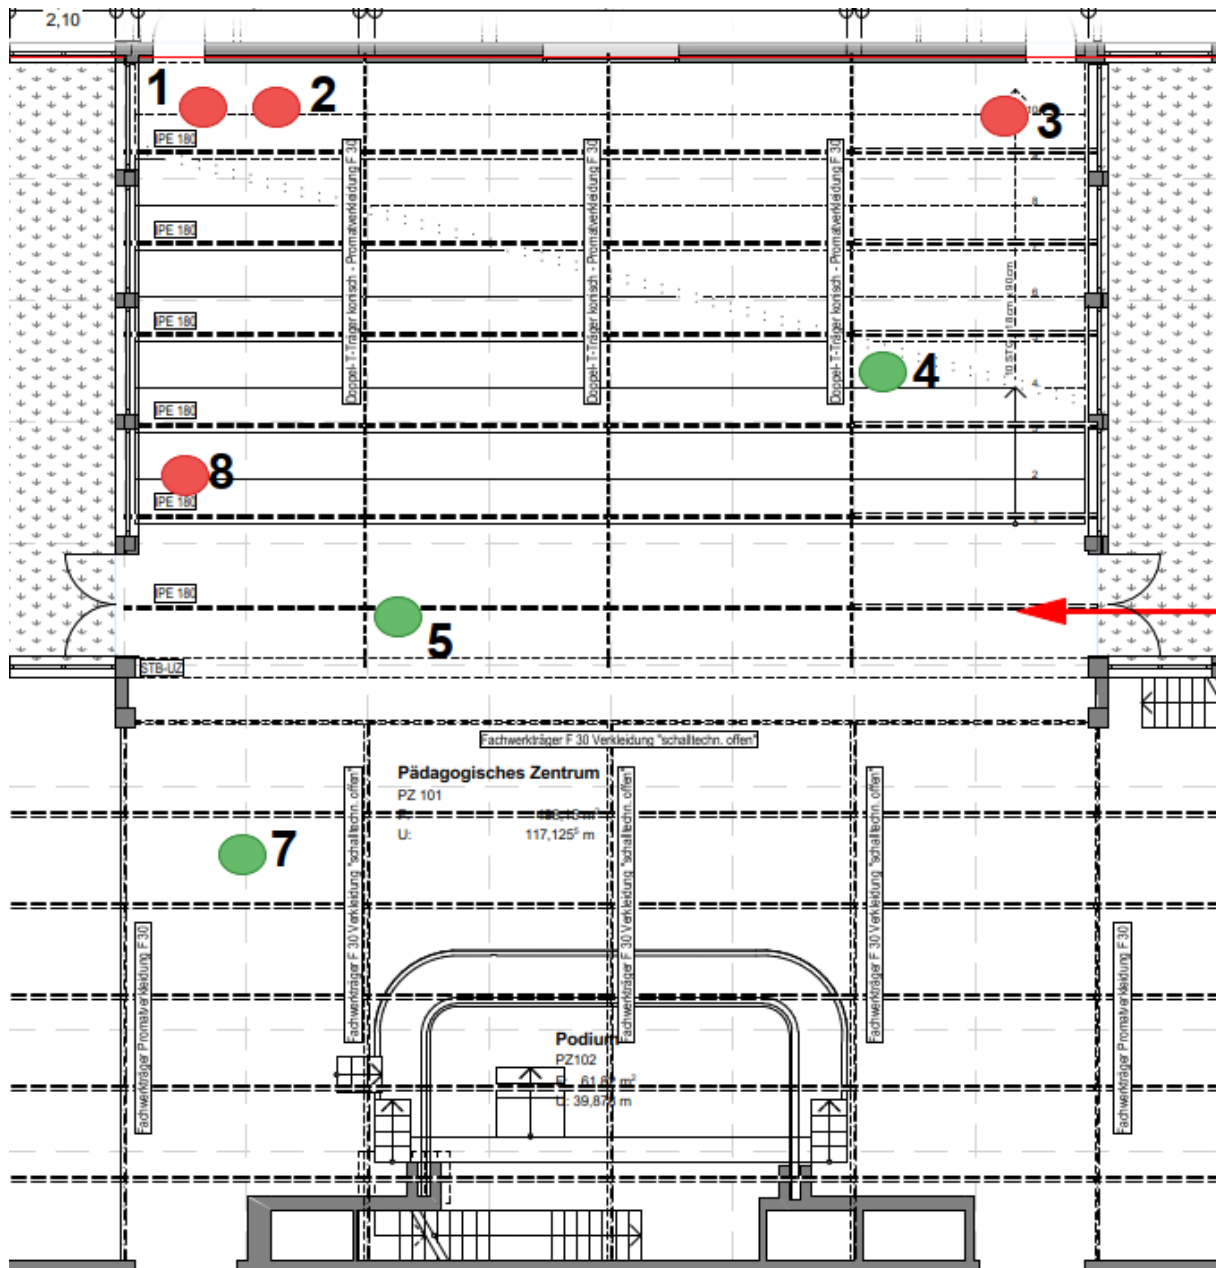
Grundrissausschnitt Ebene 1 (grün = ohne Befund, rot = Befund)
